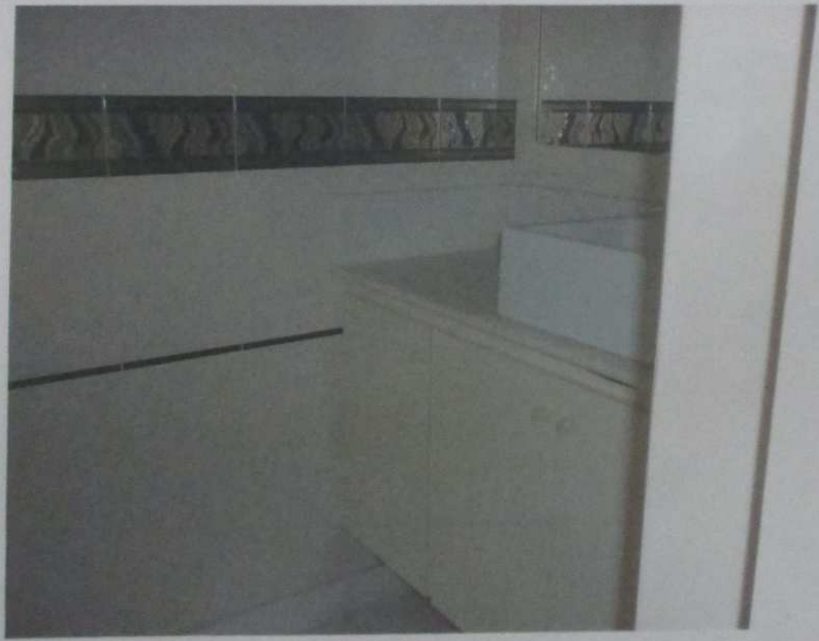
Vista do banheiro da 2ª suíte do imóvel.
